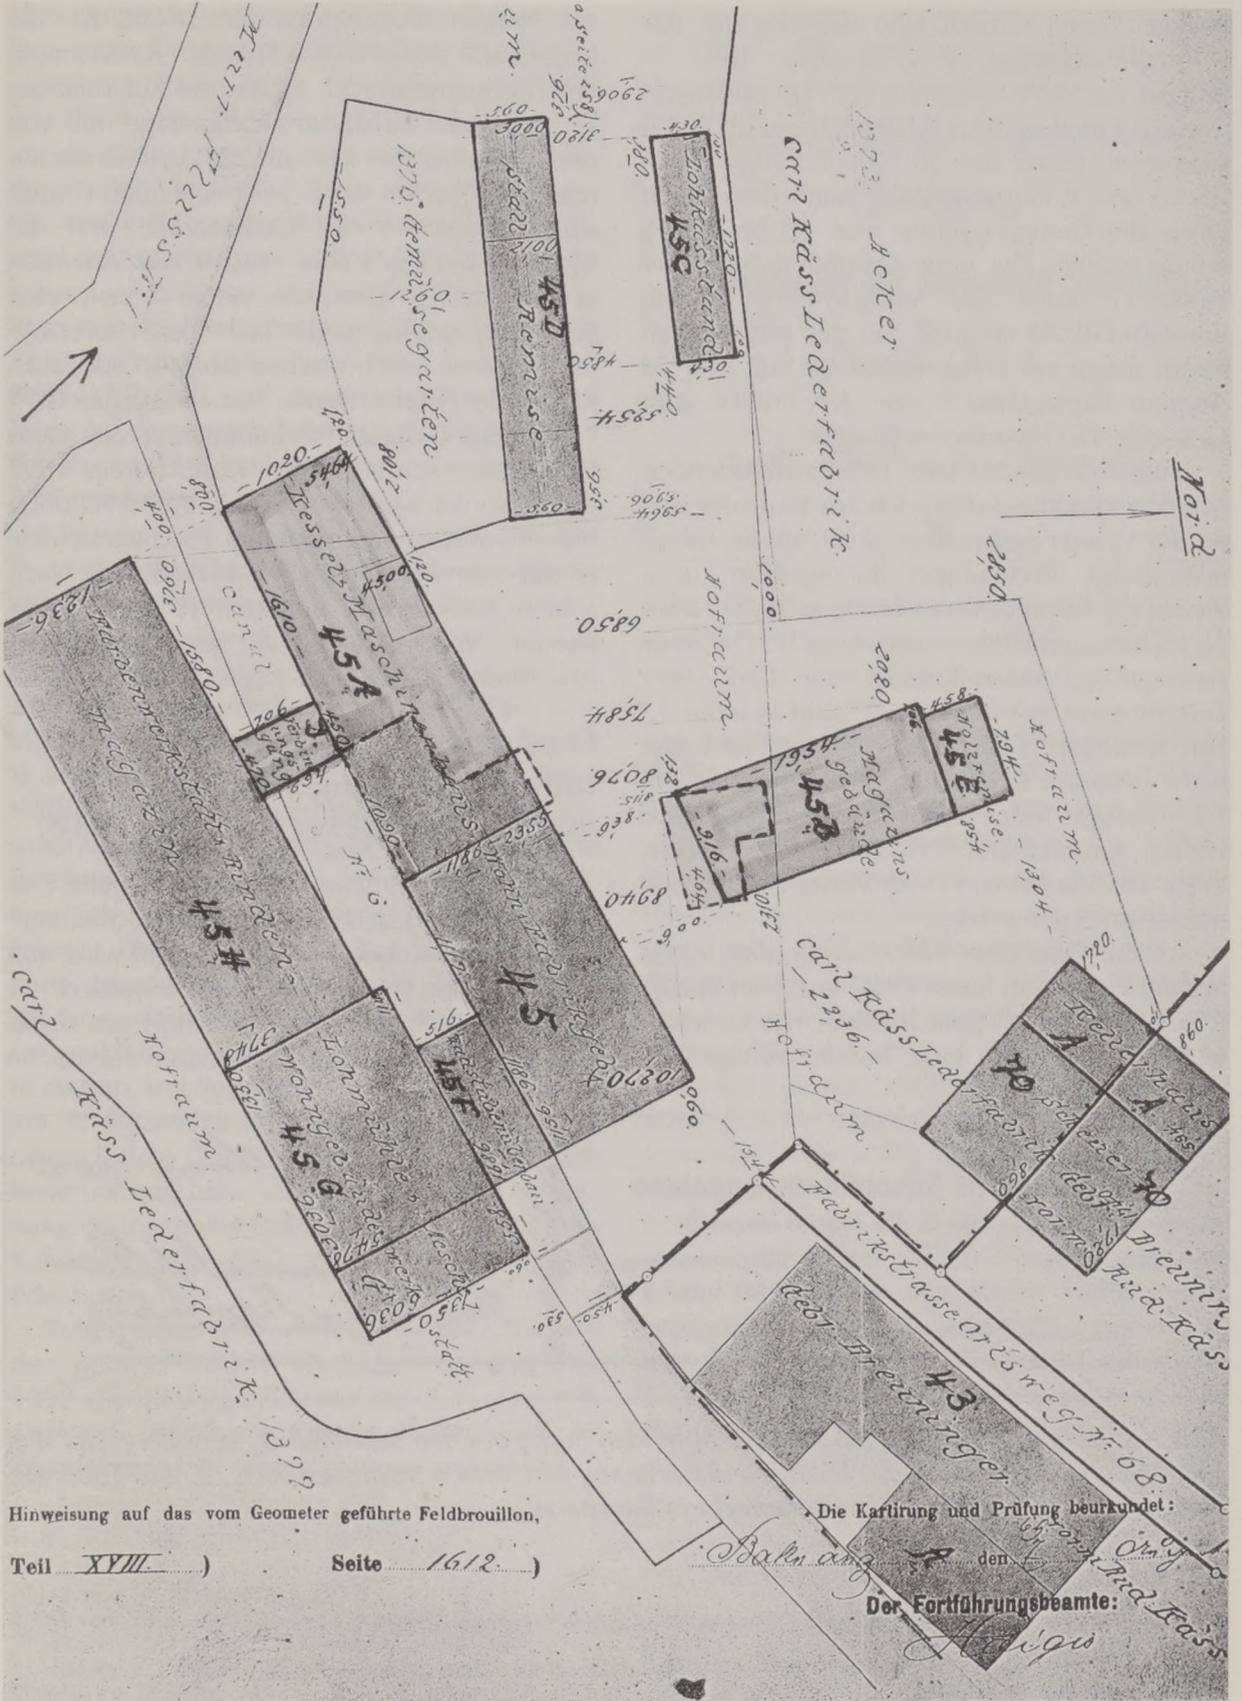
Lageplan von der Fabrik in der Unteren Au mit den 1896/97 durchgeführten Erweiterungsbauten 45 A, B, E und J. Bei Rudolf Kaess ist jetzt Gebr. Breuninger, vorm. Rudolf Kaess, eingetragen.
